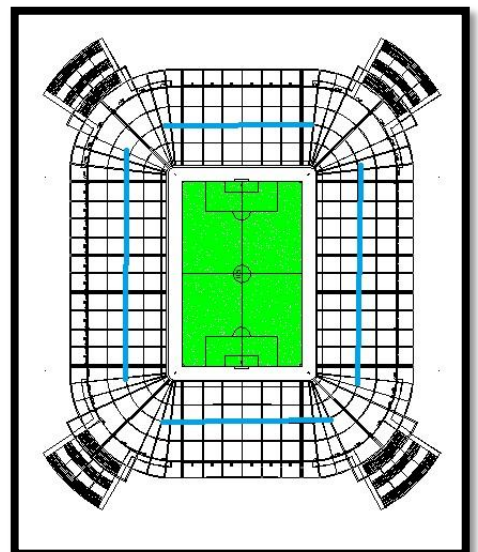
Plan de toiture du stade. ¹⁶⁷
